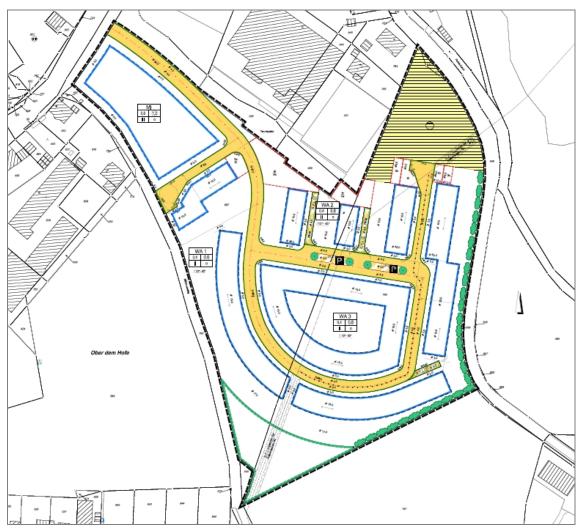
B-Planentwurf (Quelle: STADT VELBERT, Planausschnitt - Stand März 2016)
